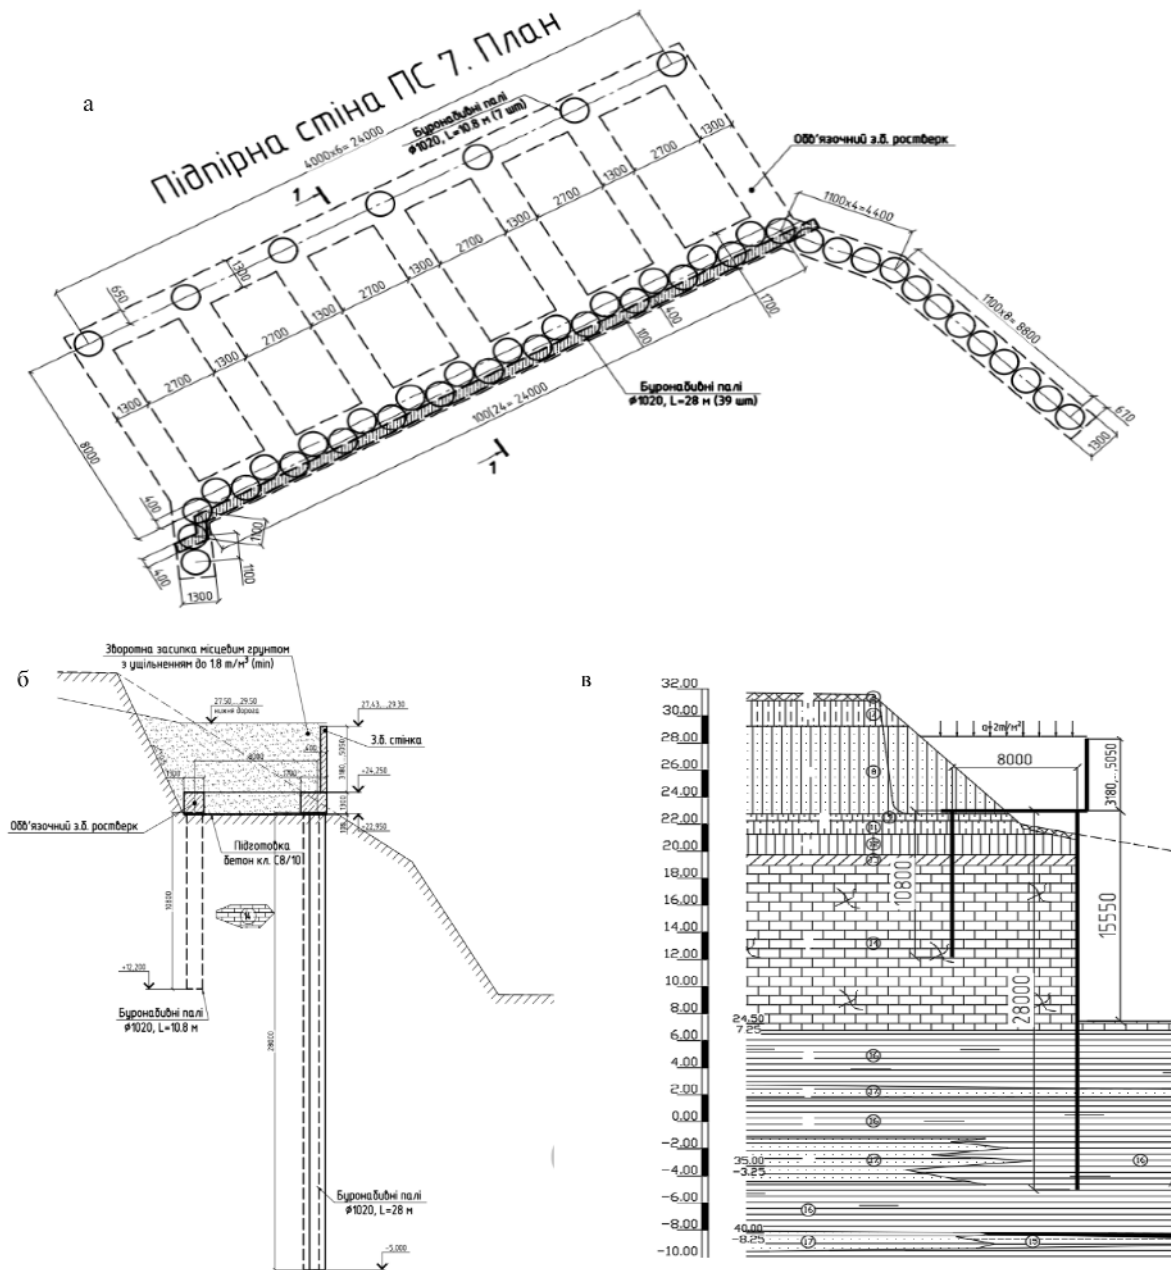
План і розріз підпірної стіни: а) план підпірної стіни; б) розріз підпірної стіни; в) схема підпірної стіни ПС 7 з урахуванням перспективних планів з благоустрою ділянки
